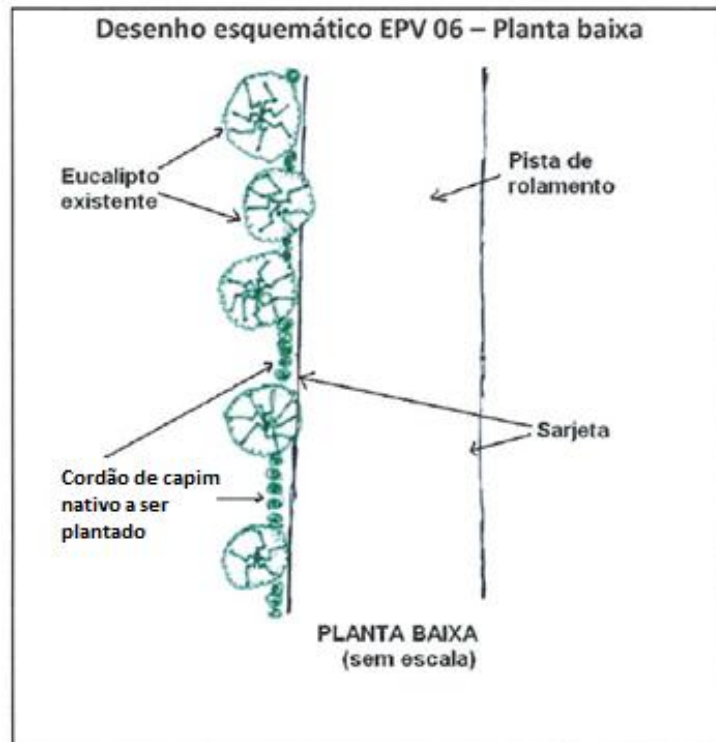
Desenho esquemático EPV 06 – Planta baixa
